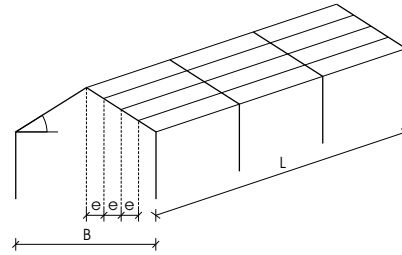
Anwendungsobjekt: Dachpfetten einer Halle
